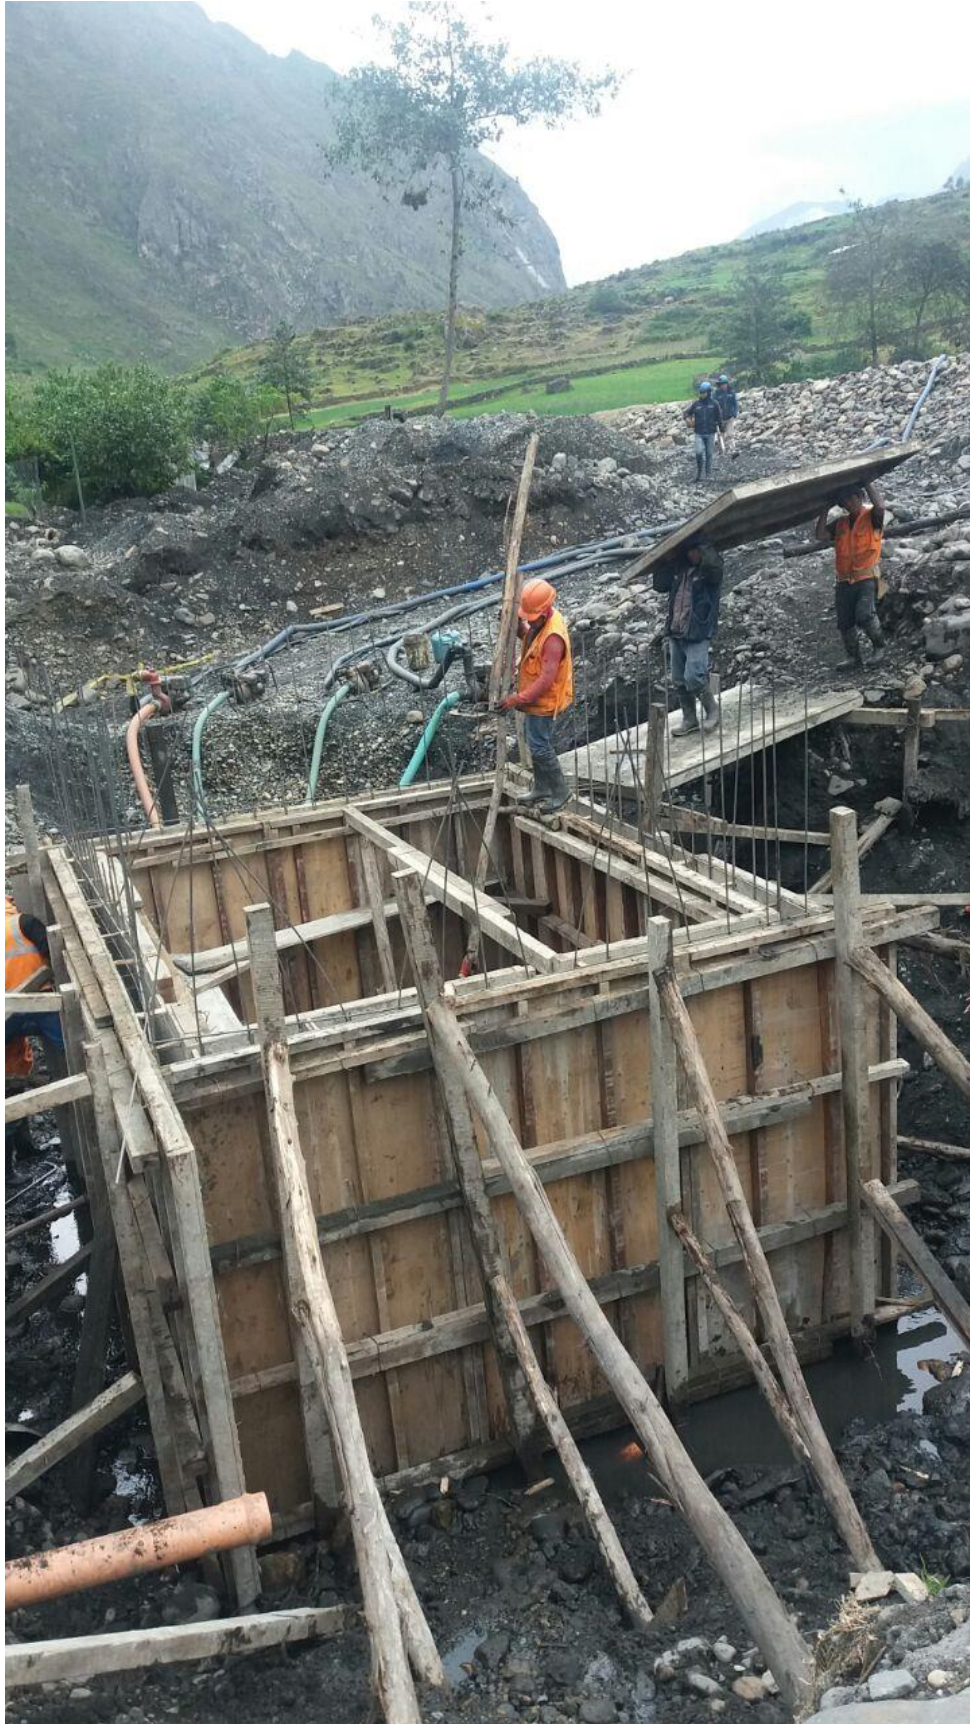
| *Encofrado de la estructura del lecho de secado de la planta de tratamiento.
